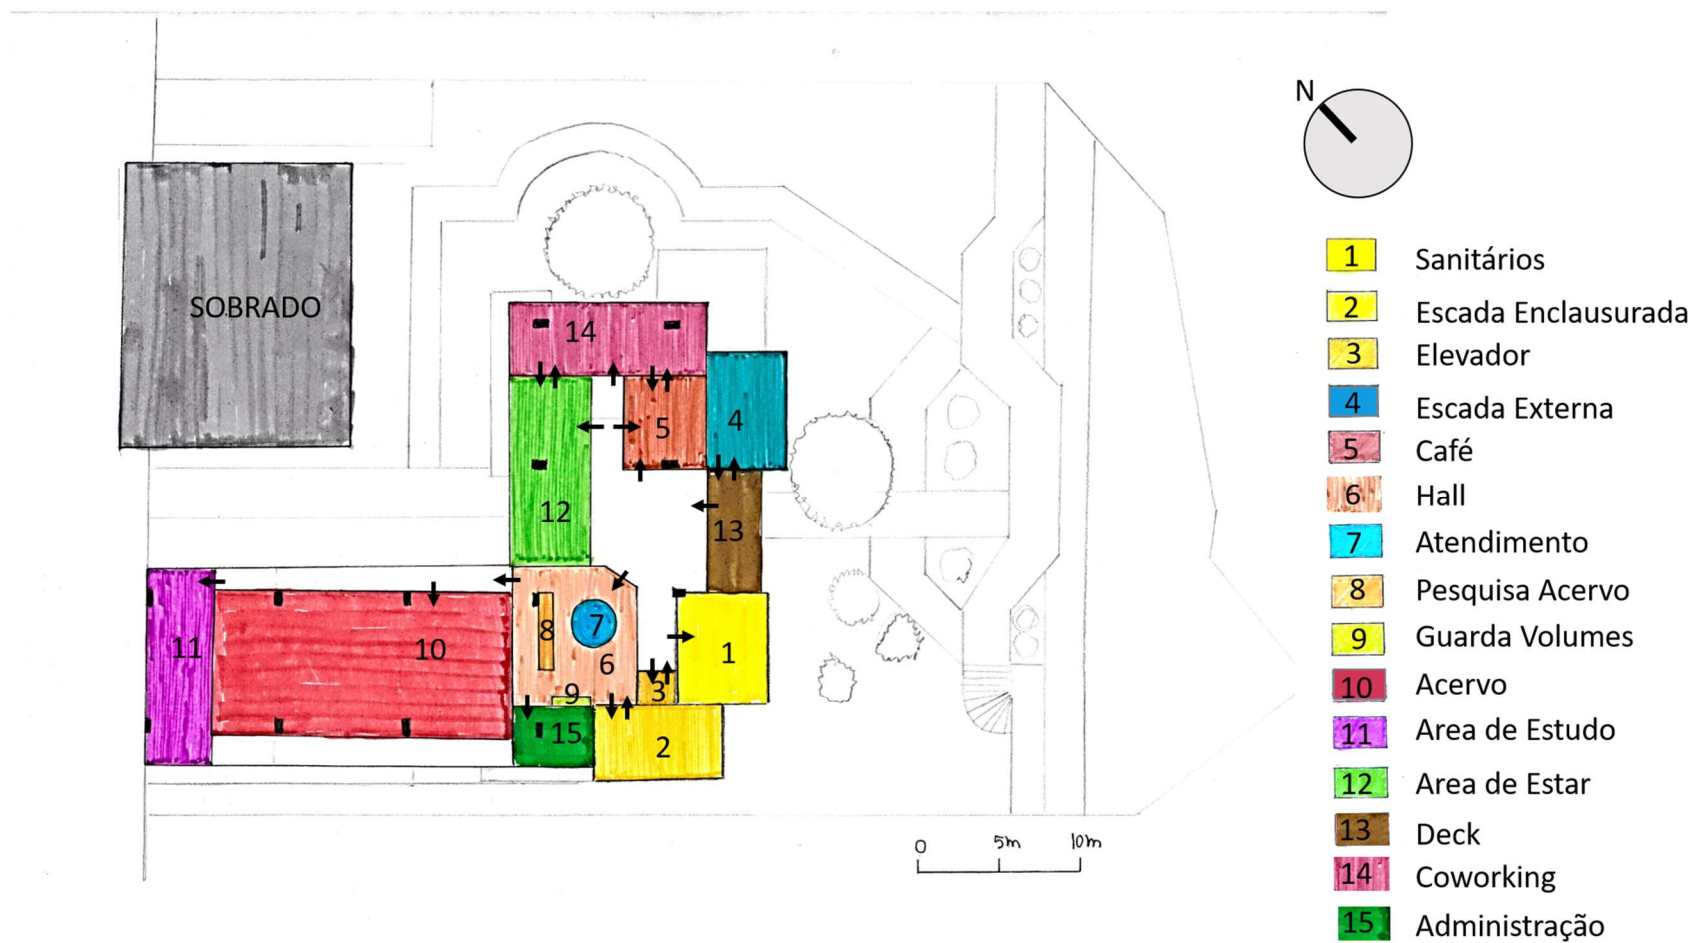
planta baixa segundo pavimento. Fonte: Arquivo pessoal
